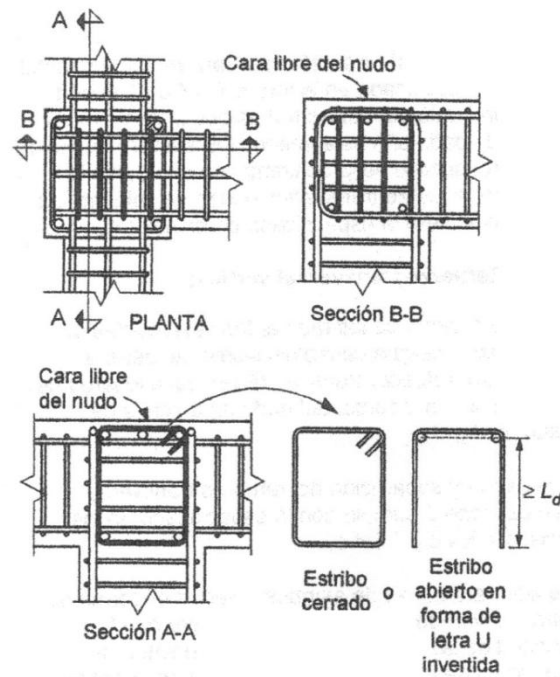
Refuerzo transversal vertical en uniones viga – columna (NTCDF).
